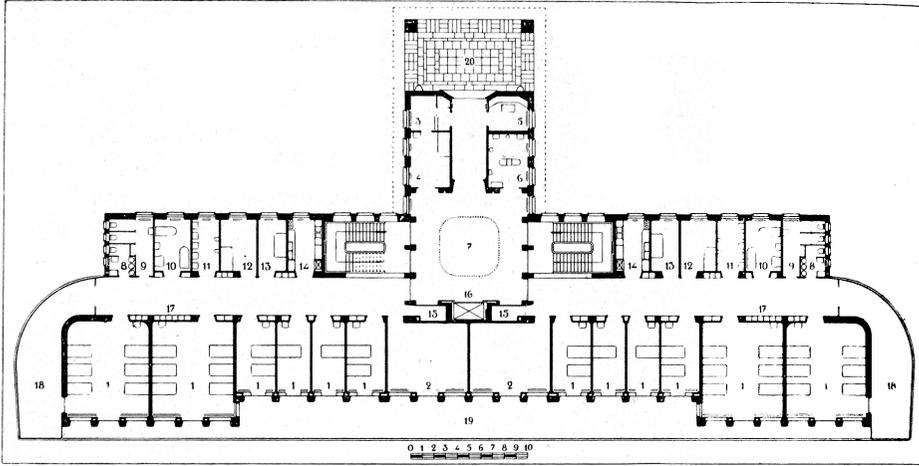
Berne, Lory-Spital (1929), plan du rez-de-chaussée (tiré de: *Werk*, 1929).
